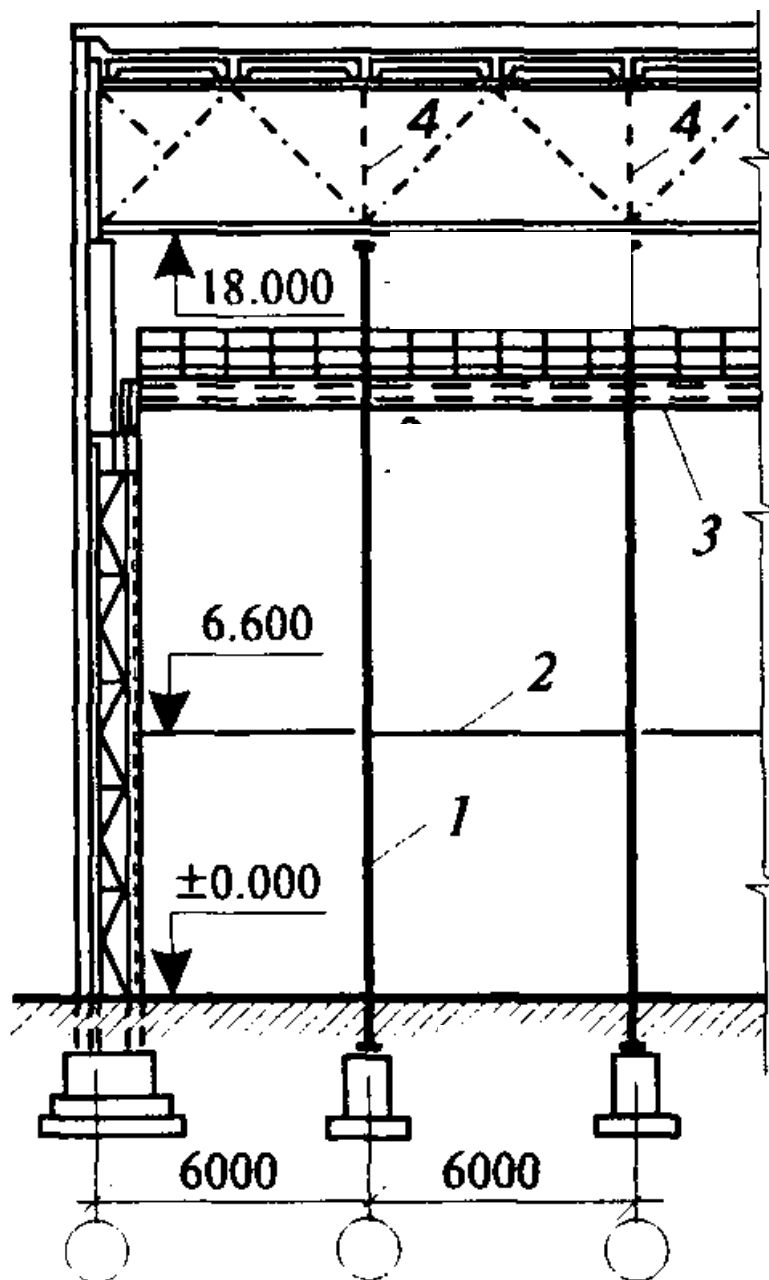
Сборные железобетонные колонны фахверка
